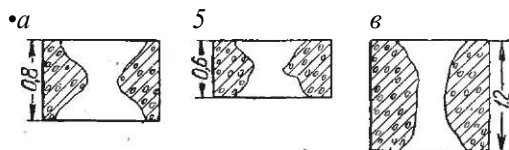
Схемы разрушения железобетонных плит наружными зарядами тротила весом 9 кг: а — обычным зарядом, прикрытым слоем забойки (песка); б — обычным зарядом без забойки; в. — ккумулятивным зарядом, расположенным на расстоянии 30 см от поверхности железобетонной плиты
